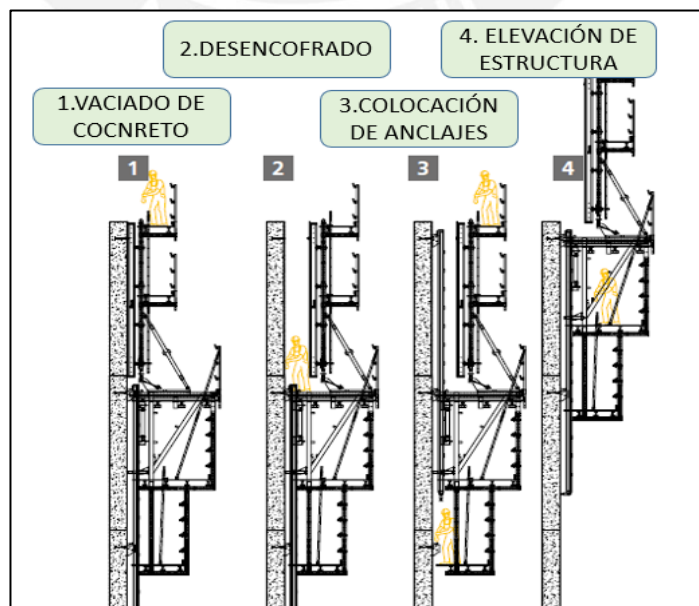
30 Secuencia de Izado del Sistema Autotrepante ATR (ULMA CONSTRUCCION, 2011)
